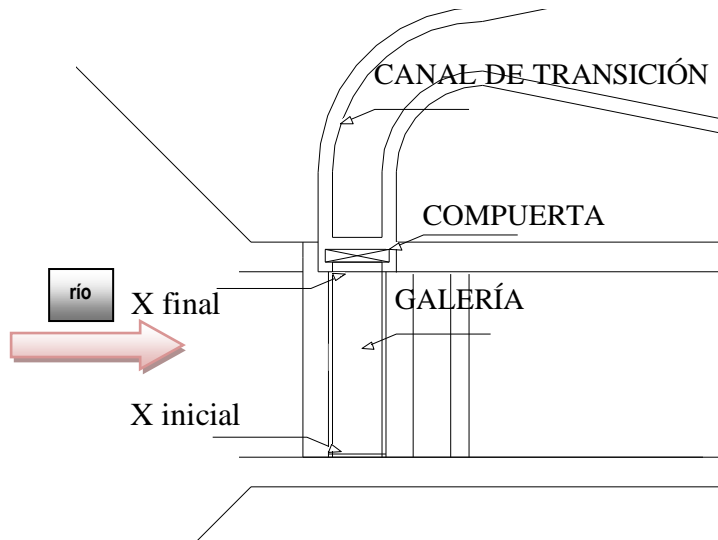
Galería vista en planta (Elaborado por Herrera Diego)
